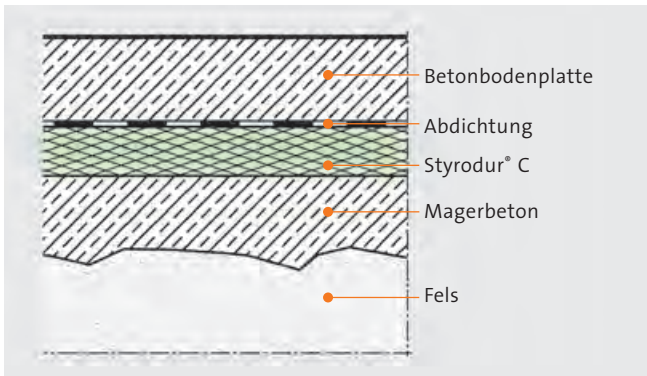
Ausgleichsschicht aus Magerbeton bei Baugrund Fels.
